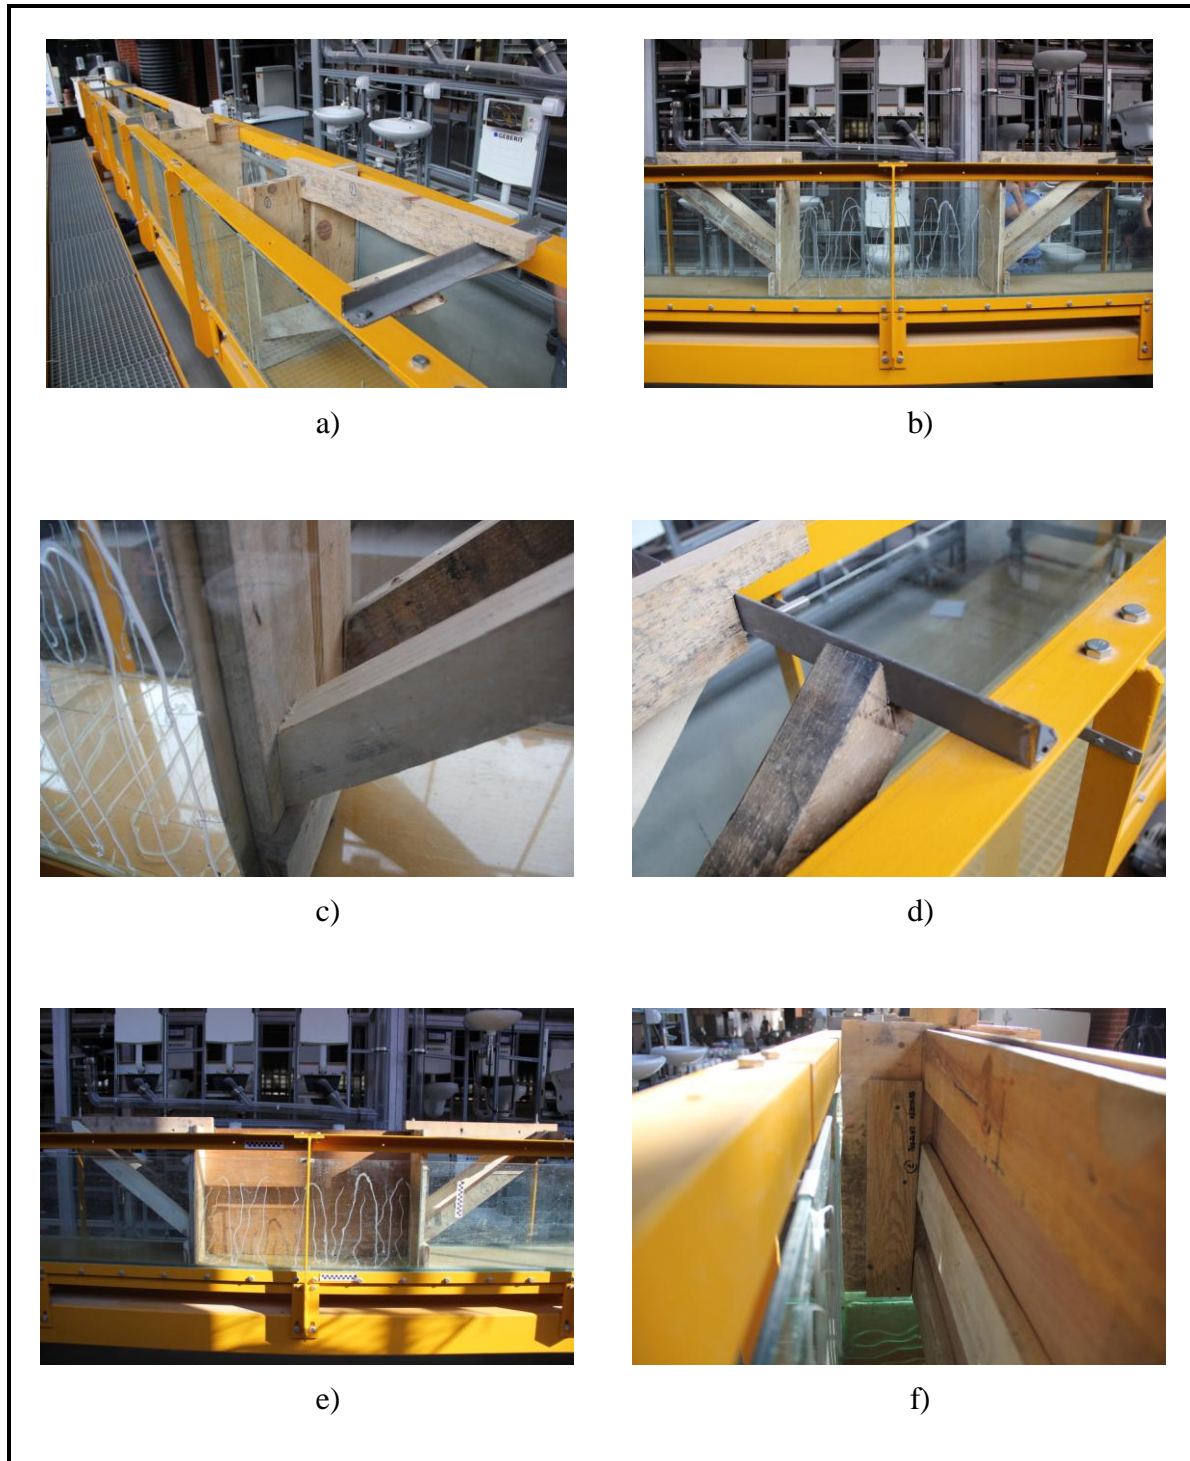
Imagens dos elementos de cofragem utilizados: a) Pormenorização dos apoios; b) Vista geral dos elementos de cofragem; c) Pormenor do escoramento na base; d) Pormenor das cunhas existentes nas escoras; e) Vista geral da cofragem dos muros sujeitos aos ensaios de erosão lateral e frontal; f) Pormenorização do apoio da cofragem dos ensaios erosivos.
